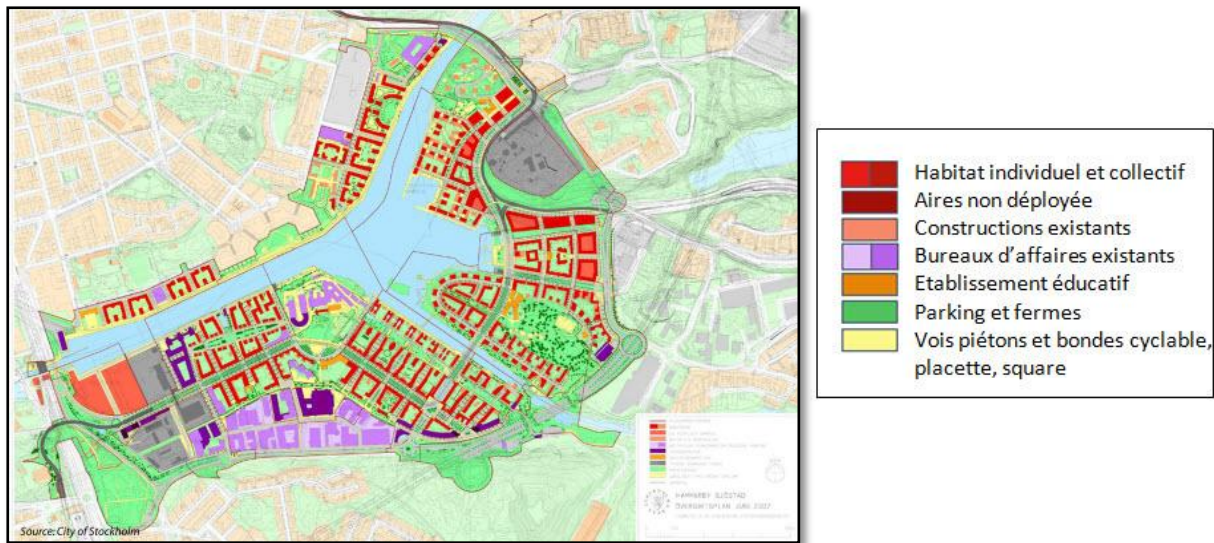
Plan de masse de Hammarby Sjostad (Source : Gaffney et Al. 2007)
